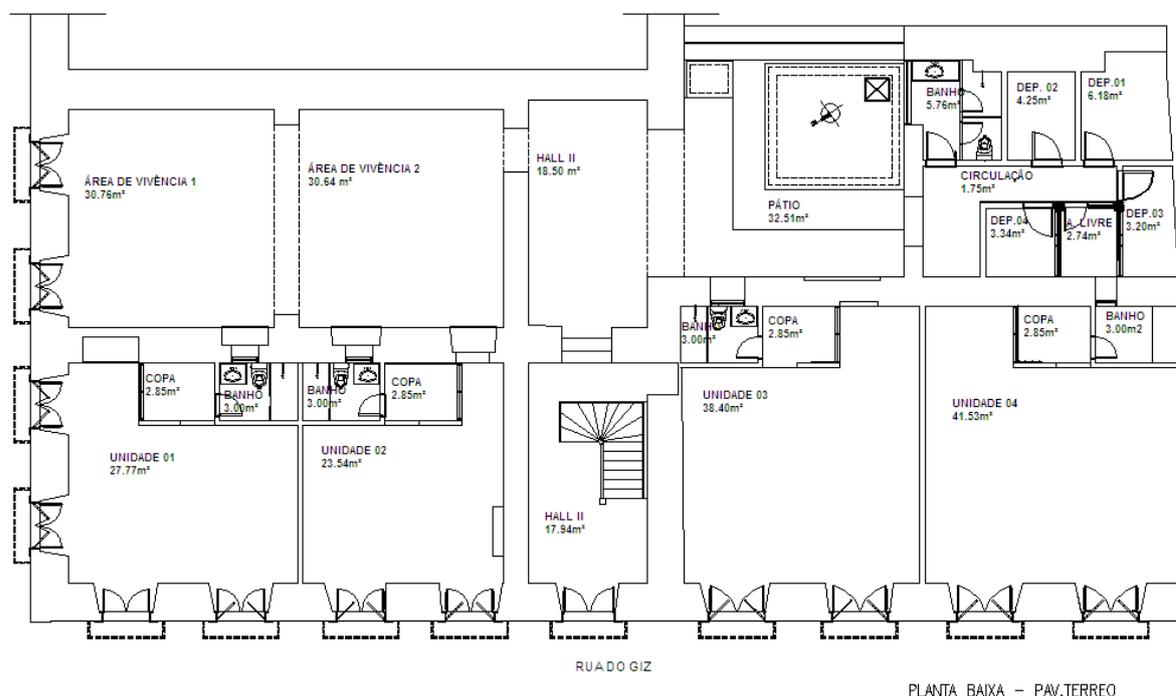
Ilustração de Planta Baixa de Pavimento Térreo
